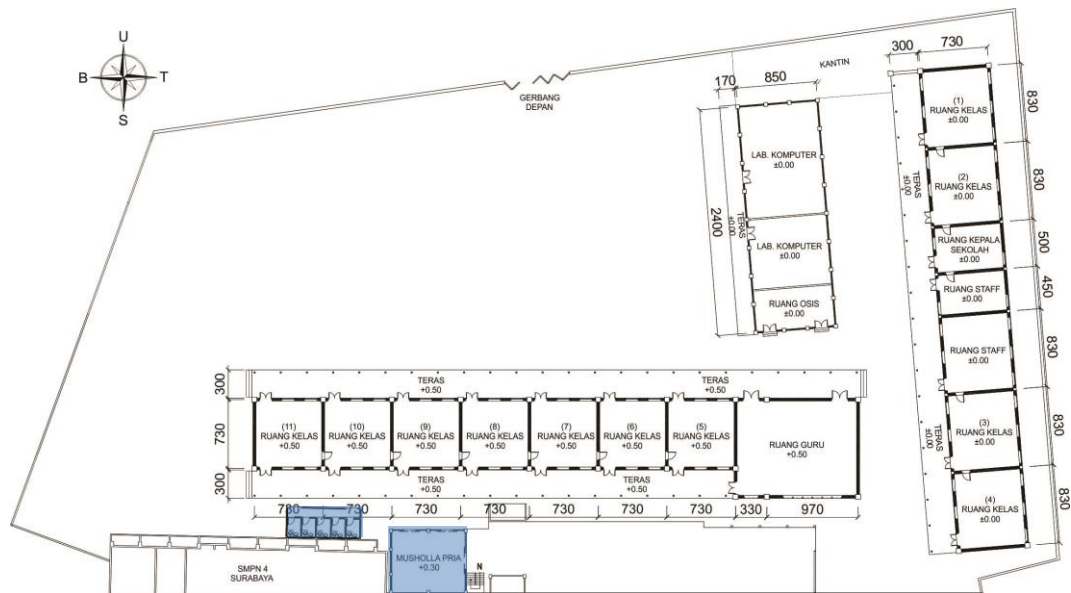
Denah Massa C SMPN 3 Surabaya
